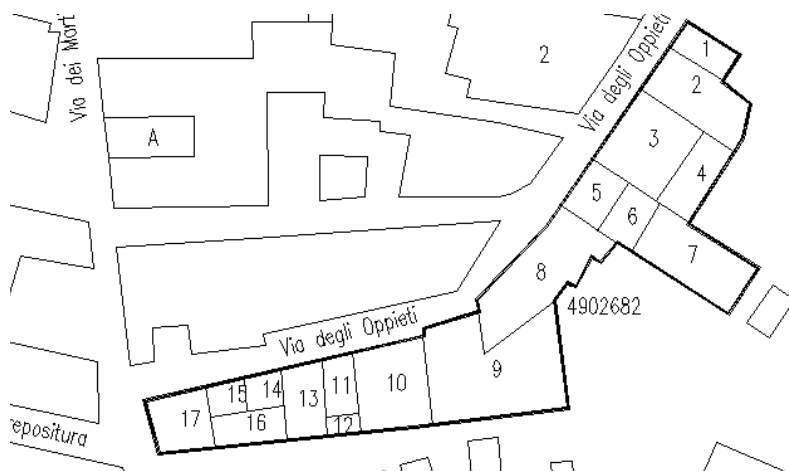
Suddivisione dell'aggregato in unità strutturali.
